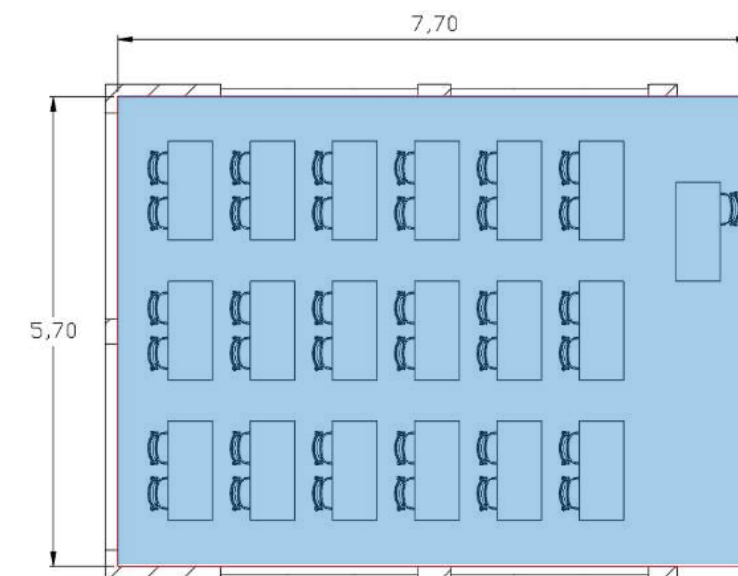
Edificio B, planta de aula tipo PB-N1. Fuente: Elaboración propia.
